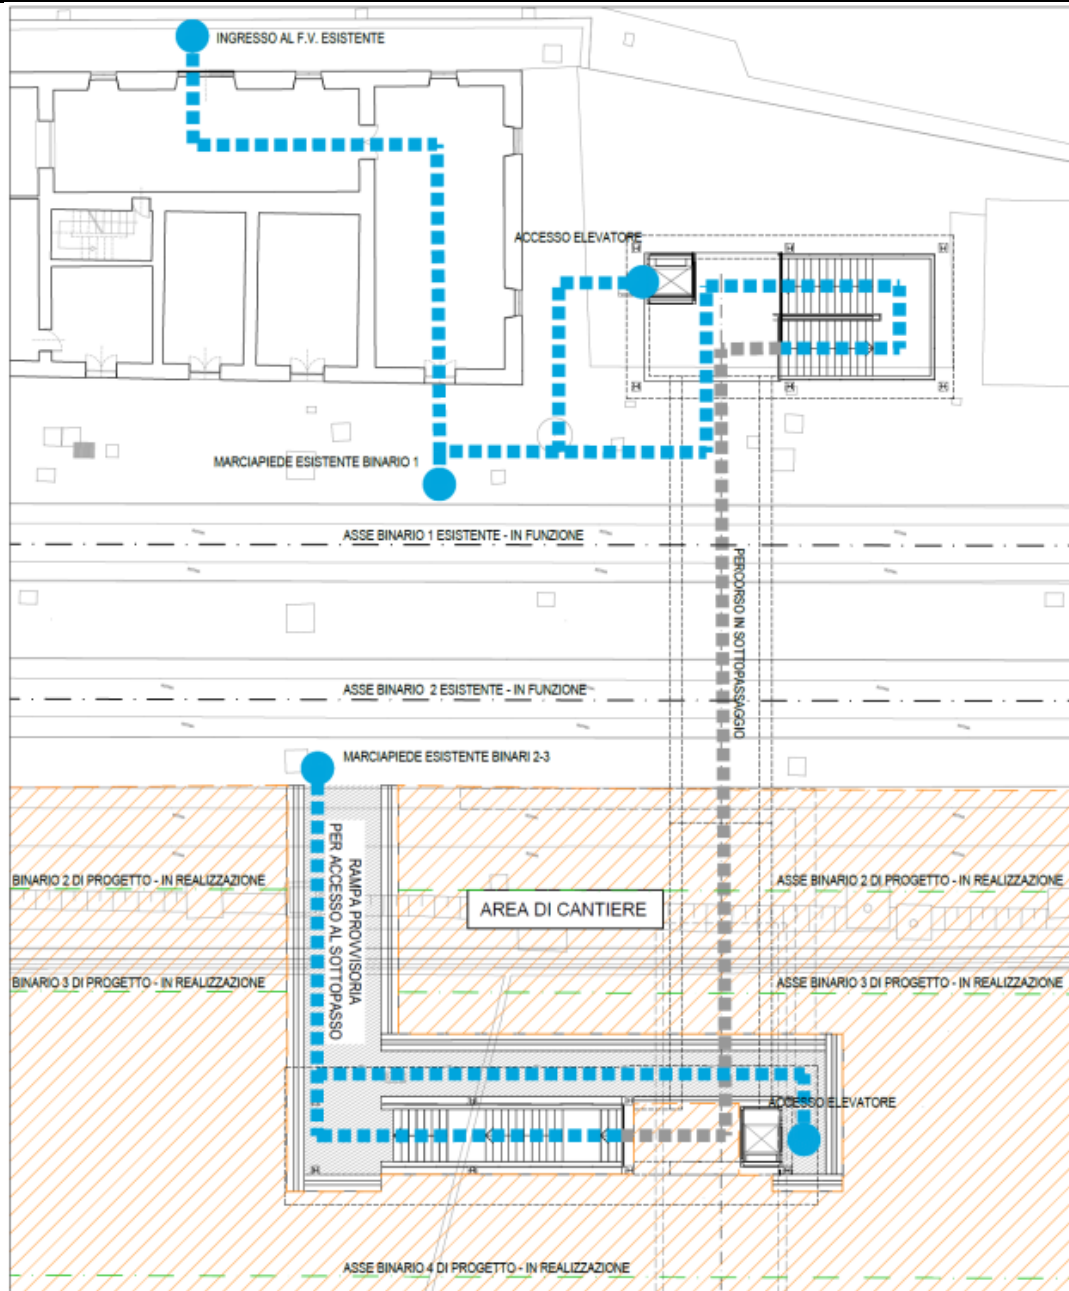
Planimetria di fase 1.1 con percorso protetto (puntinato in blu) dall'ingresso stazione al nuovo marciapiede temporaneo a servizio del binario II
